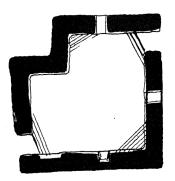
مقعد عائلة ابو حمام - مسقط أفقى
